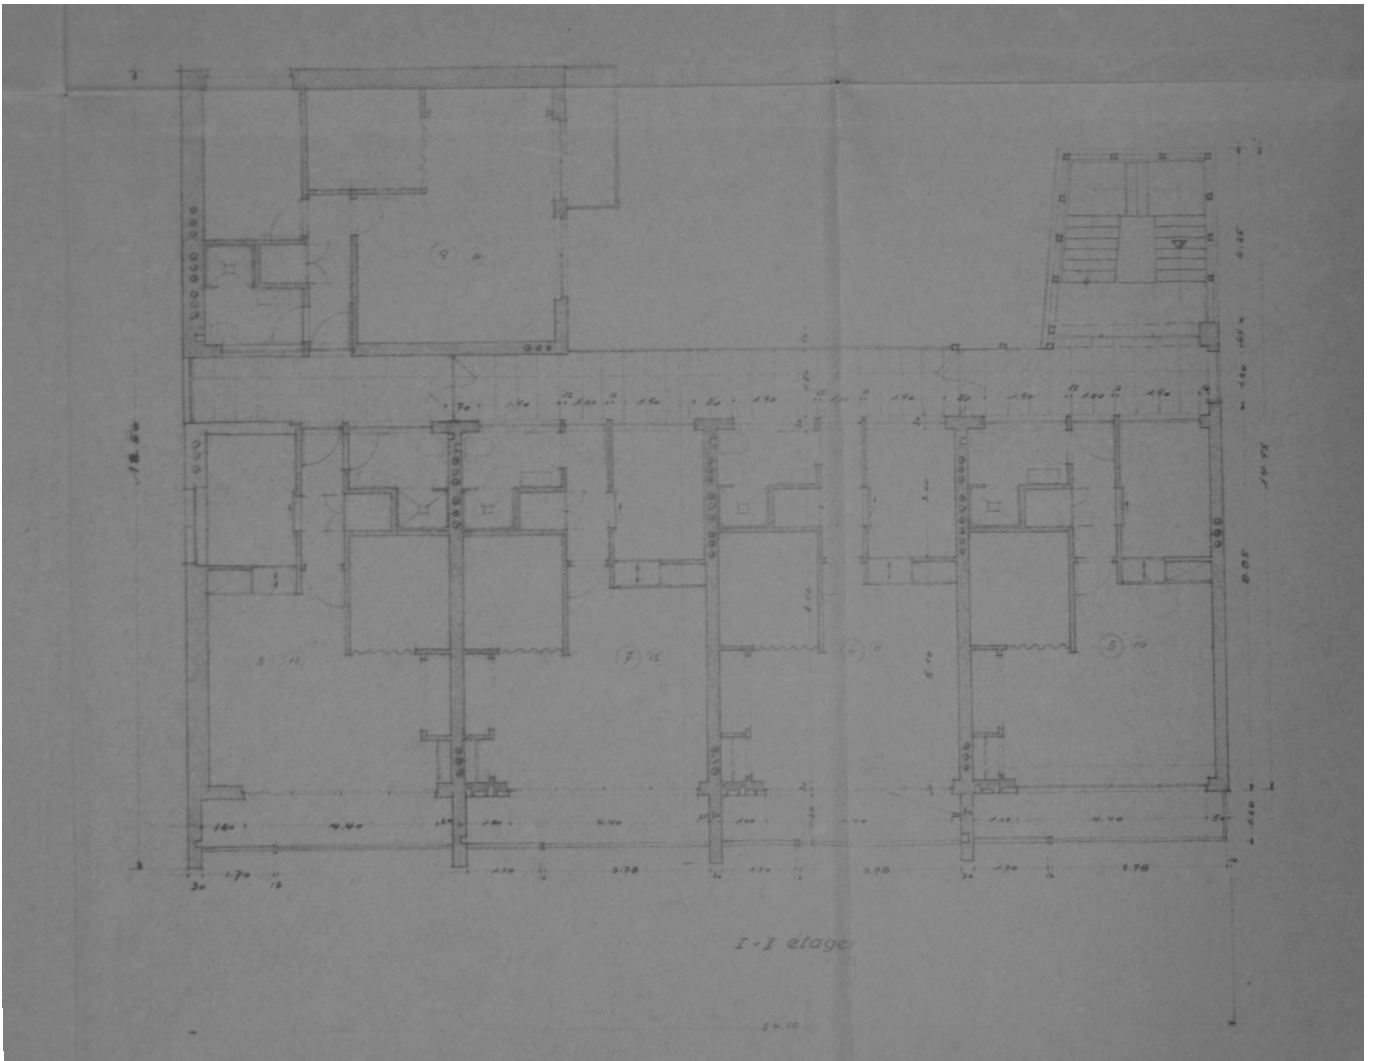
Grundriss, Regelgeschoß mit fünf Wohneinheiten (1953)
